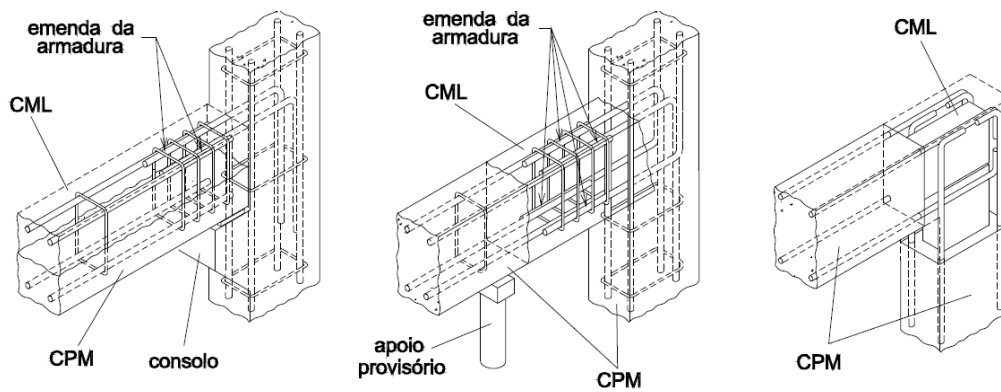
Ligações viga-pilar rígidas com emenda da armadura e concreto moldado no local [El Debs (2000)]
